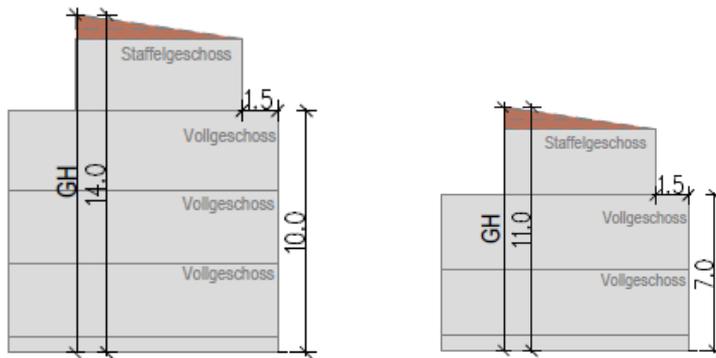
Schemaschnitt Teilbereich 4 und 1 entlang der General-von-Holzling Straße
